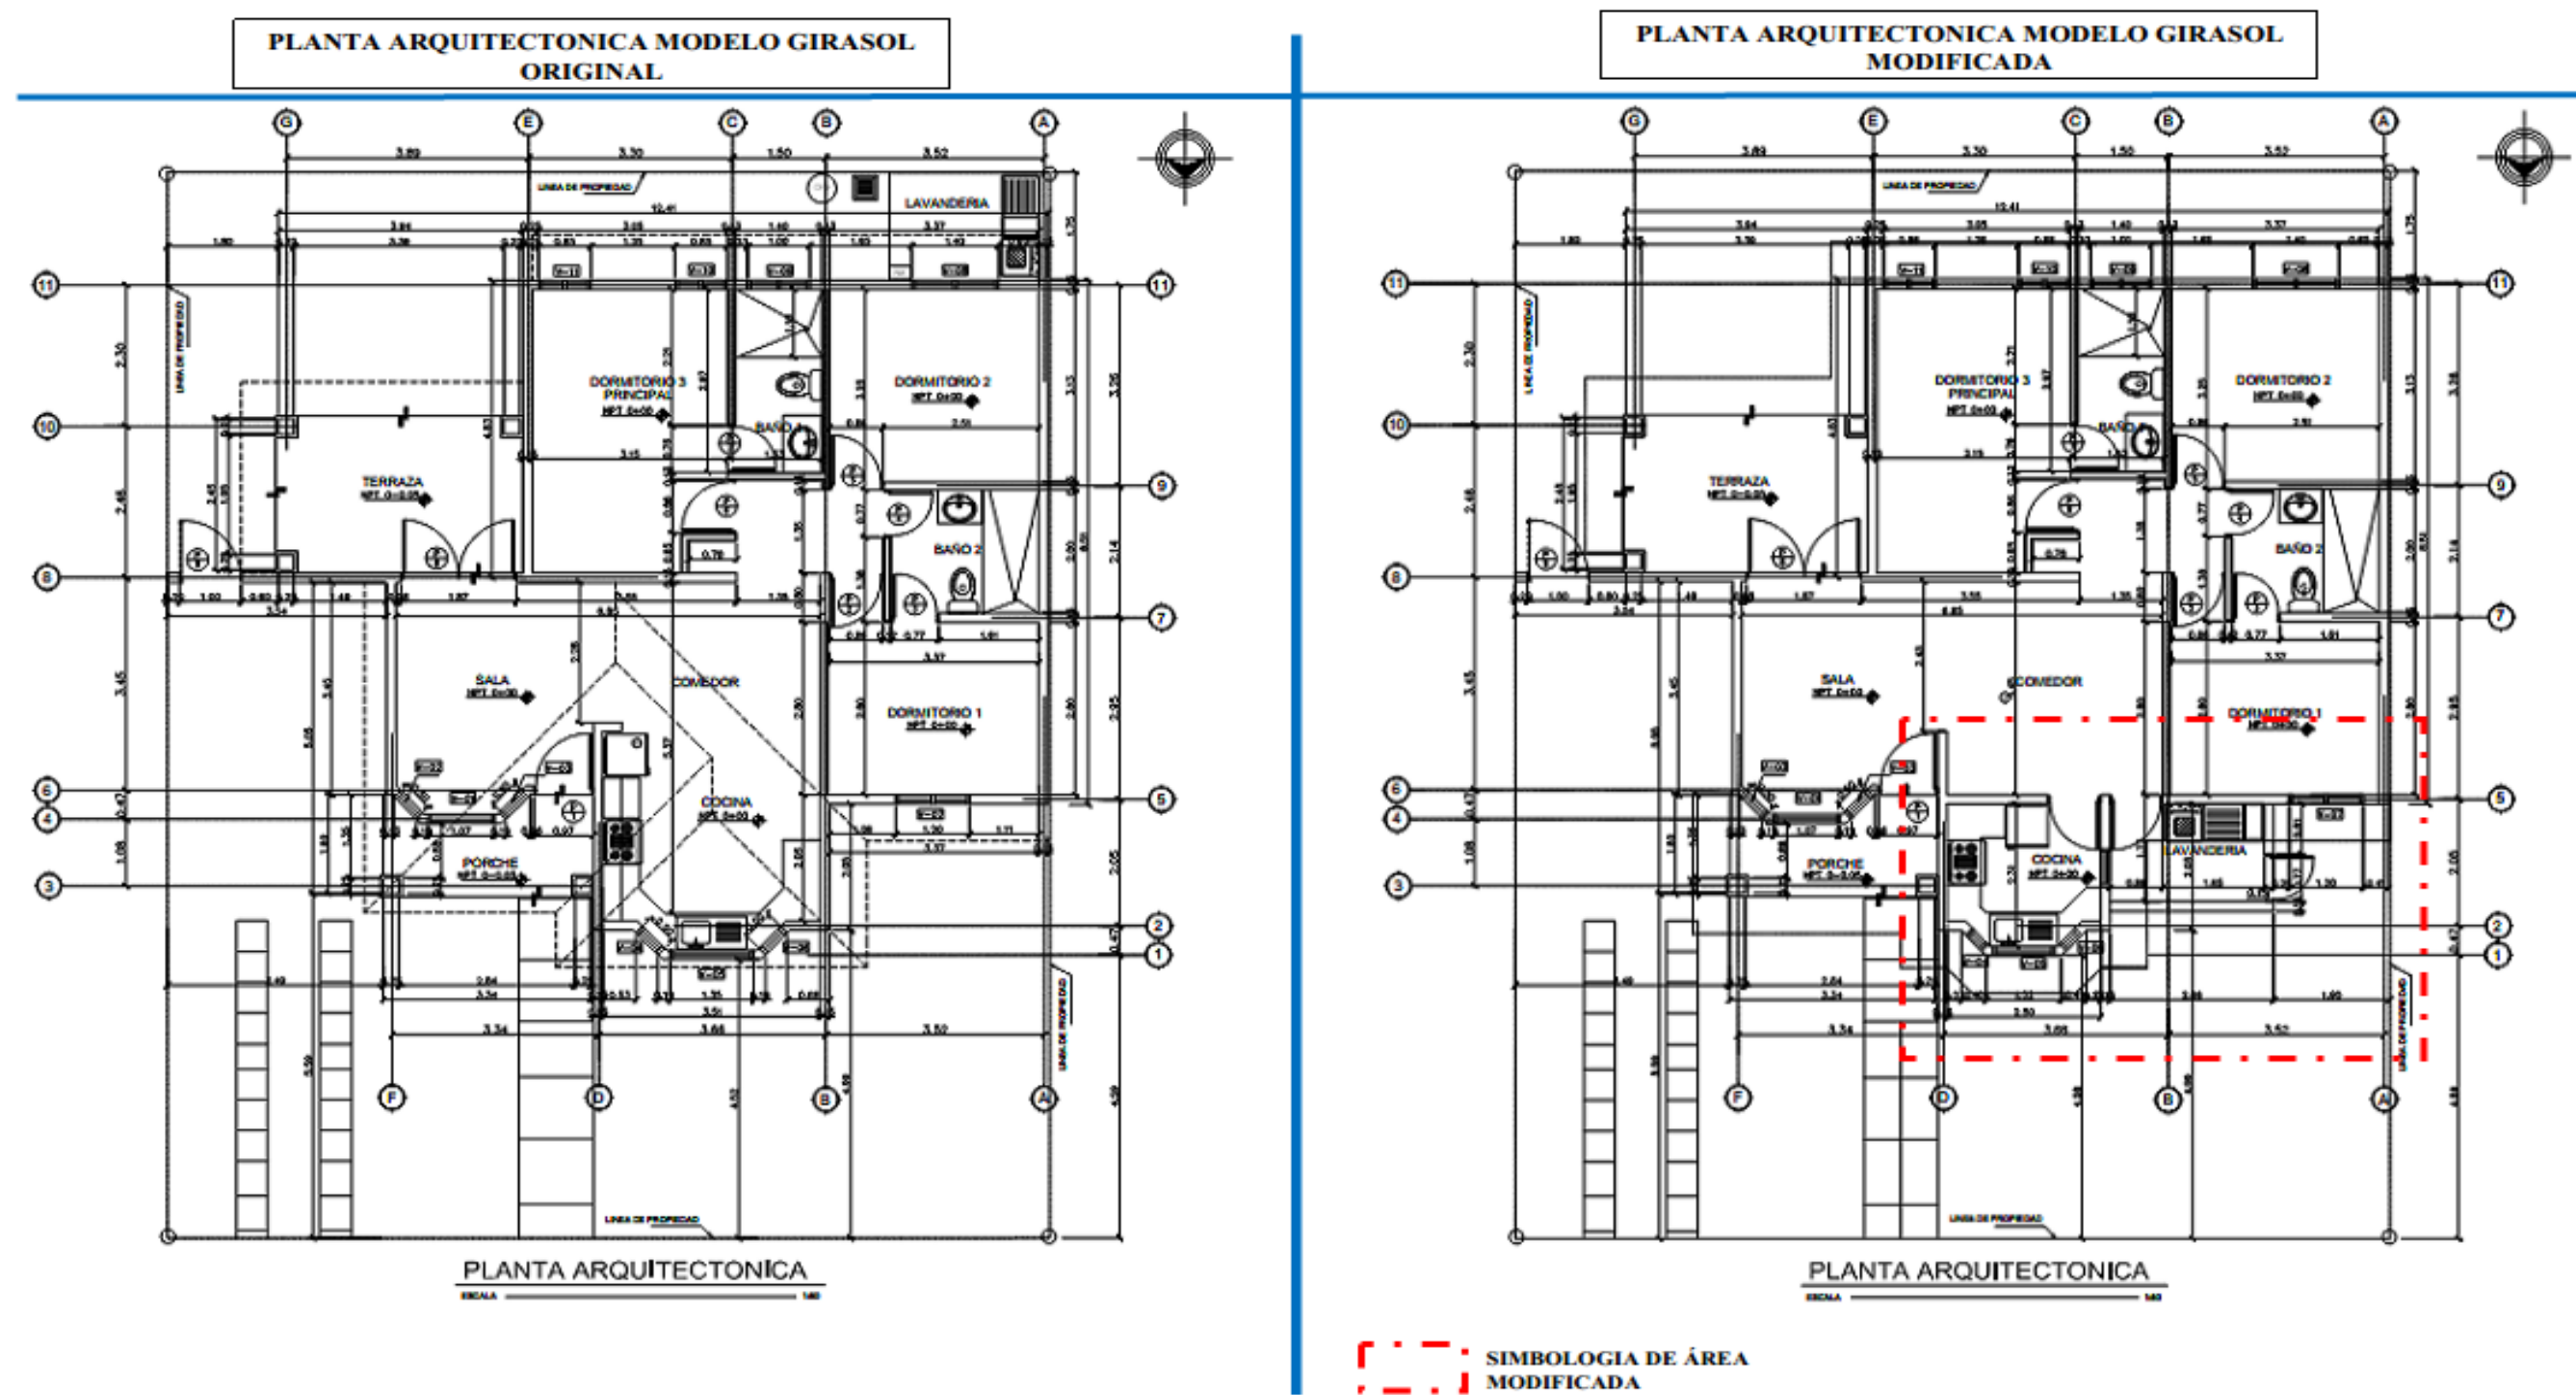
, Modificación en distribución de Planta Arquitectónica.
